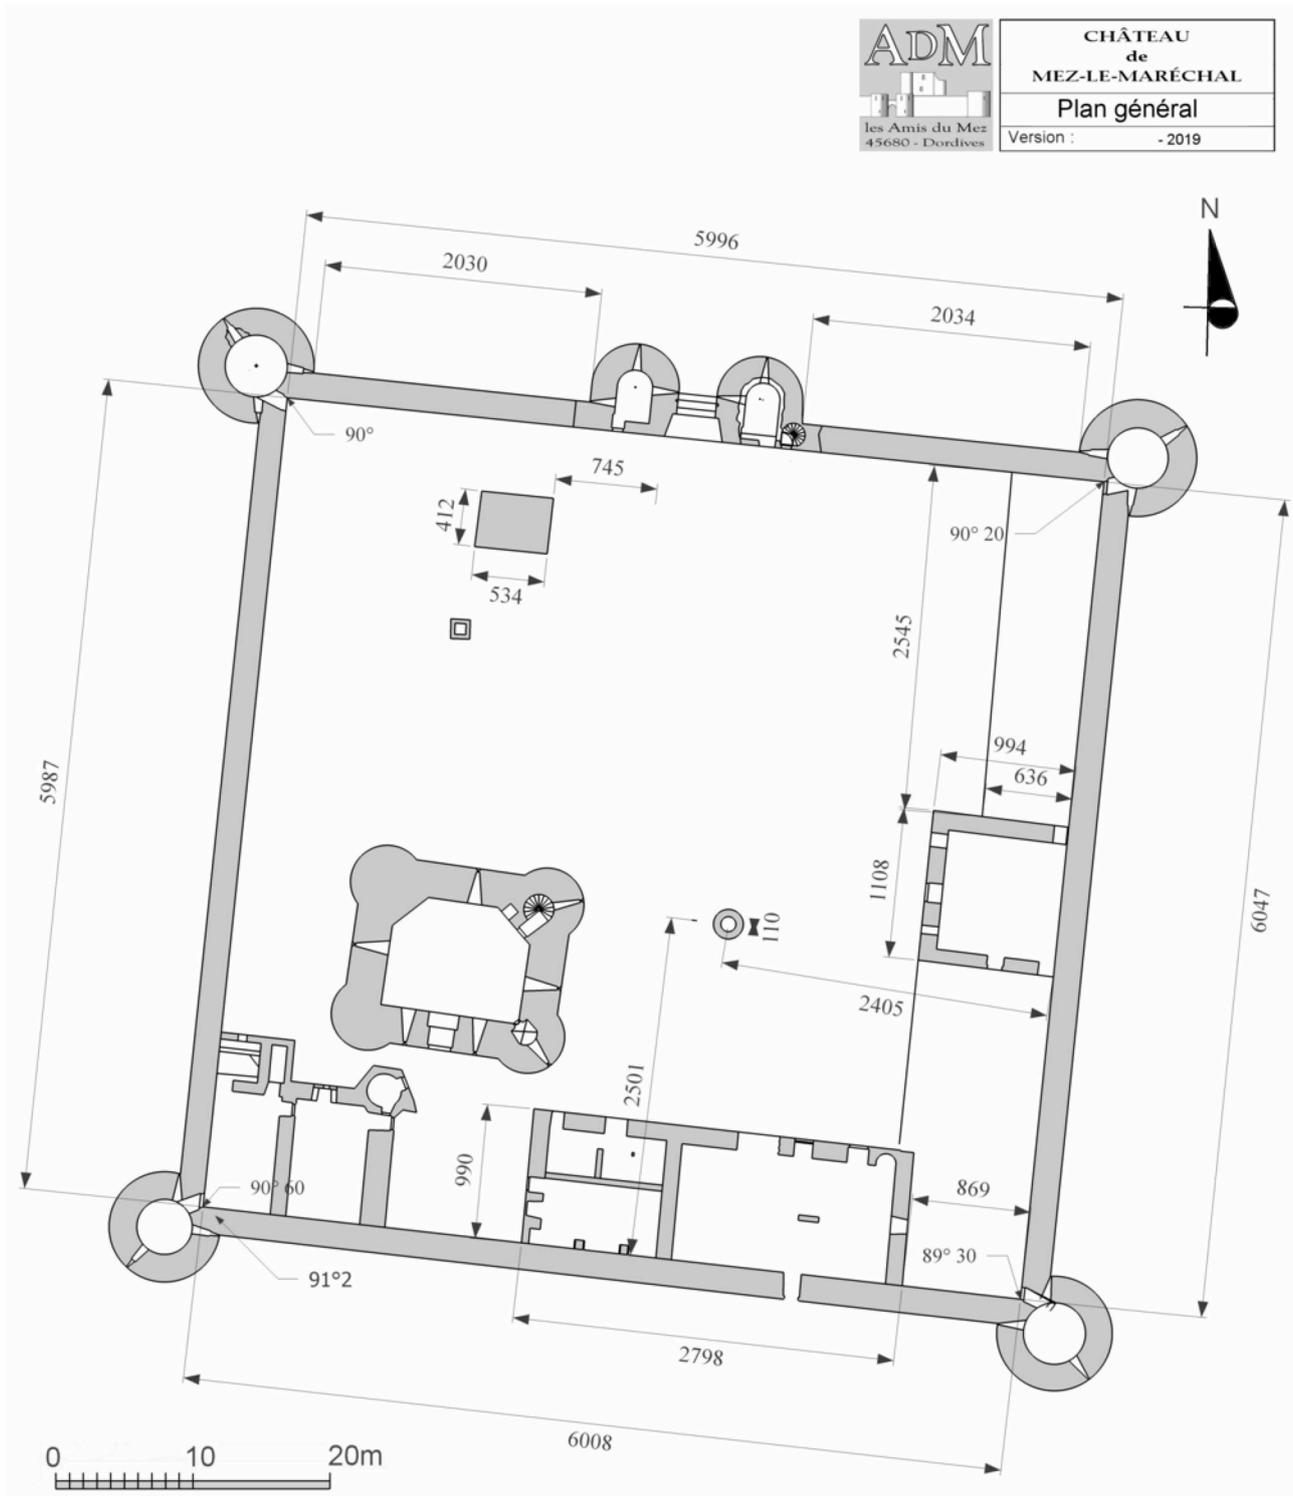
Plan général au niveau du sol (DAO : Michel Piechaczyk, Xavier Bignon / ADM).
